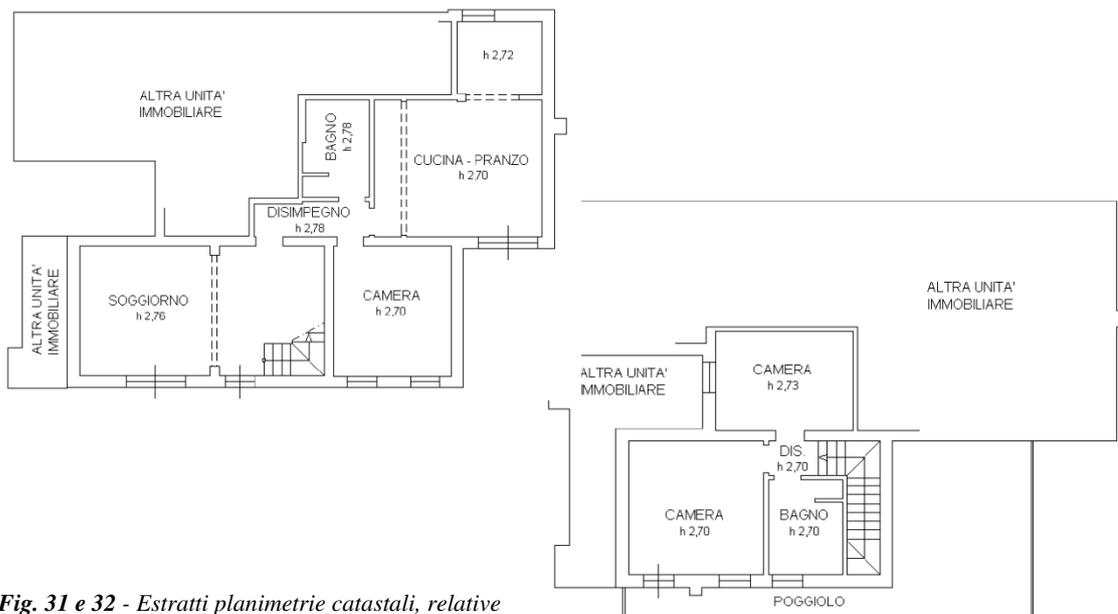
e 32 - Estratti planimetrie catastali, relative al piano terra (in alto) e al piano primo (a destra)
